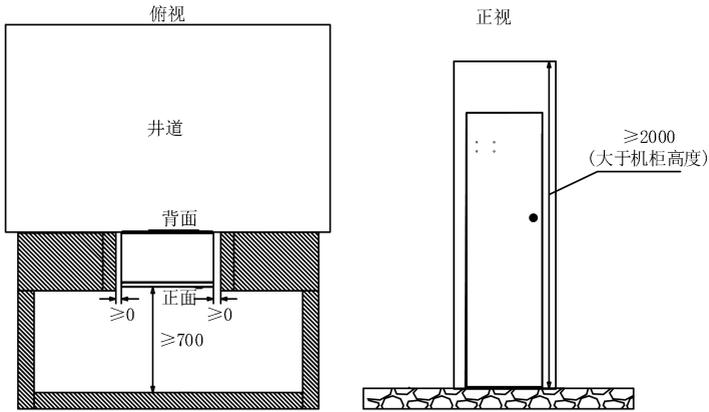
无机房控制柜安装空间要求示意图（单位：mm）
